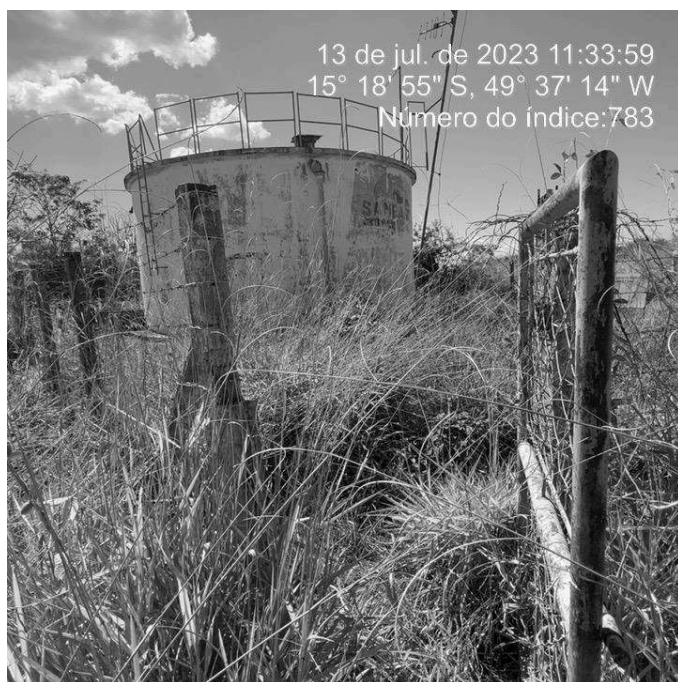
RAP 150 m³ metálico Sorriso II com pintura desgastada.
